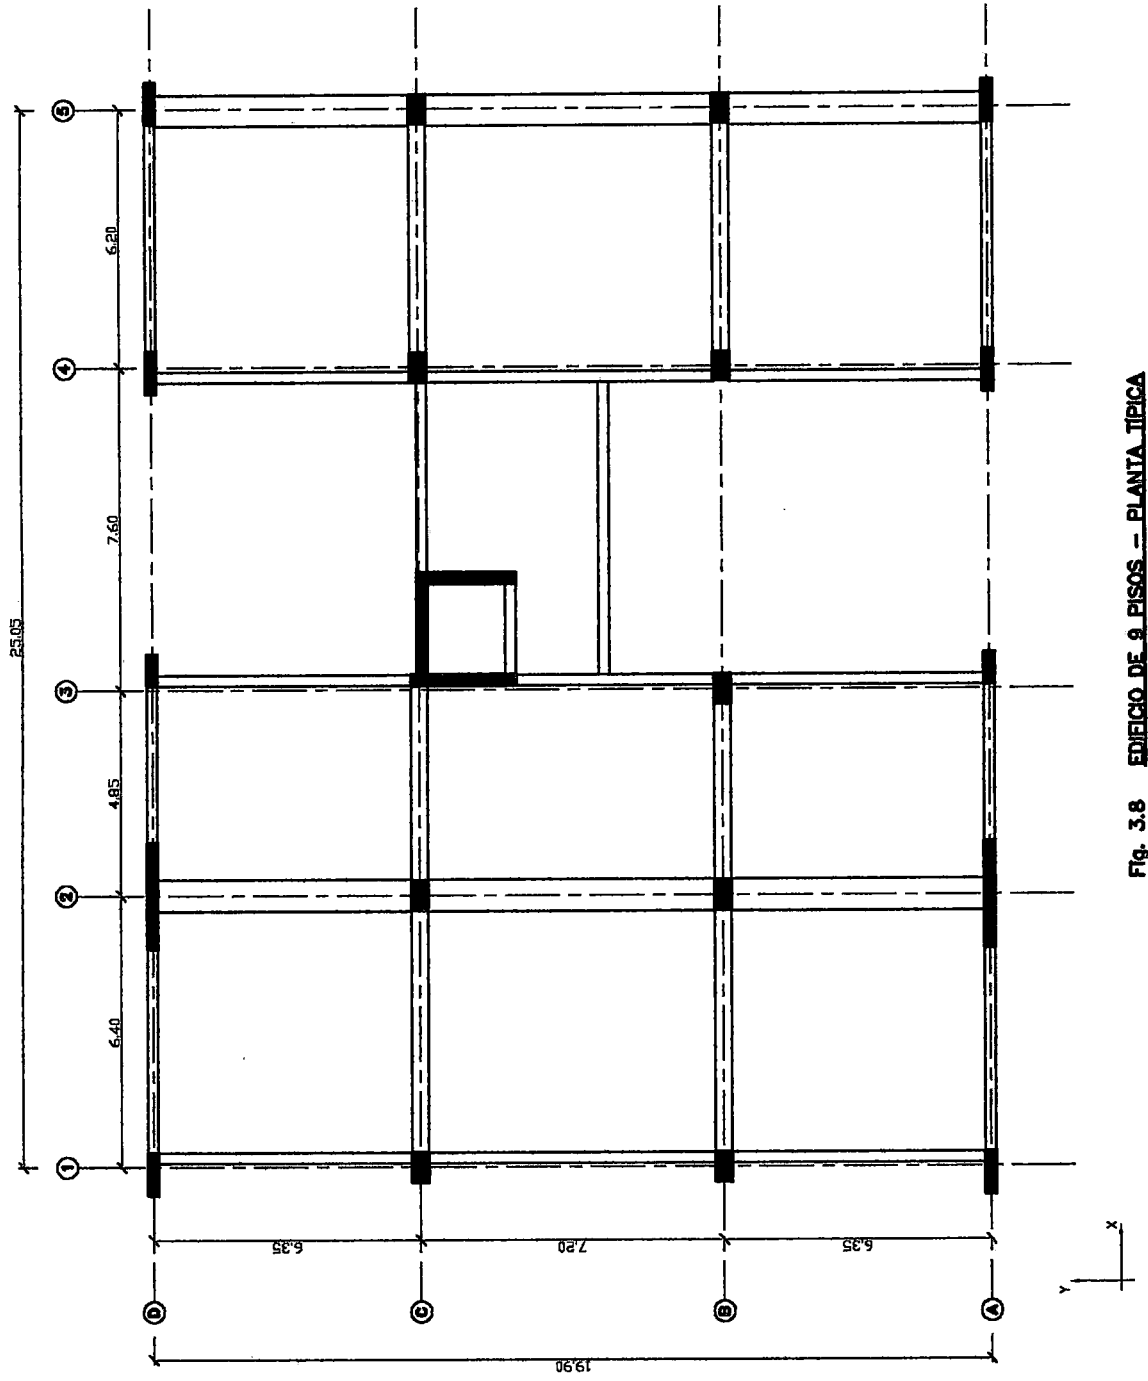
EDIFICIO DE 9 PISOS -- PLANTA TÍPICA
